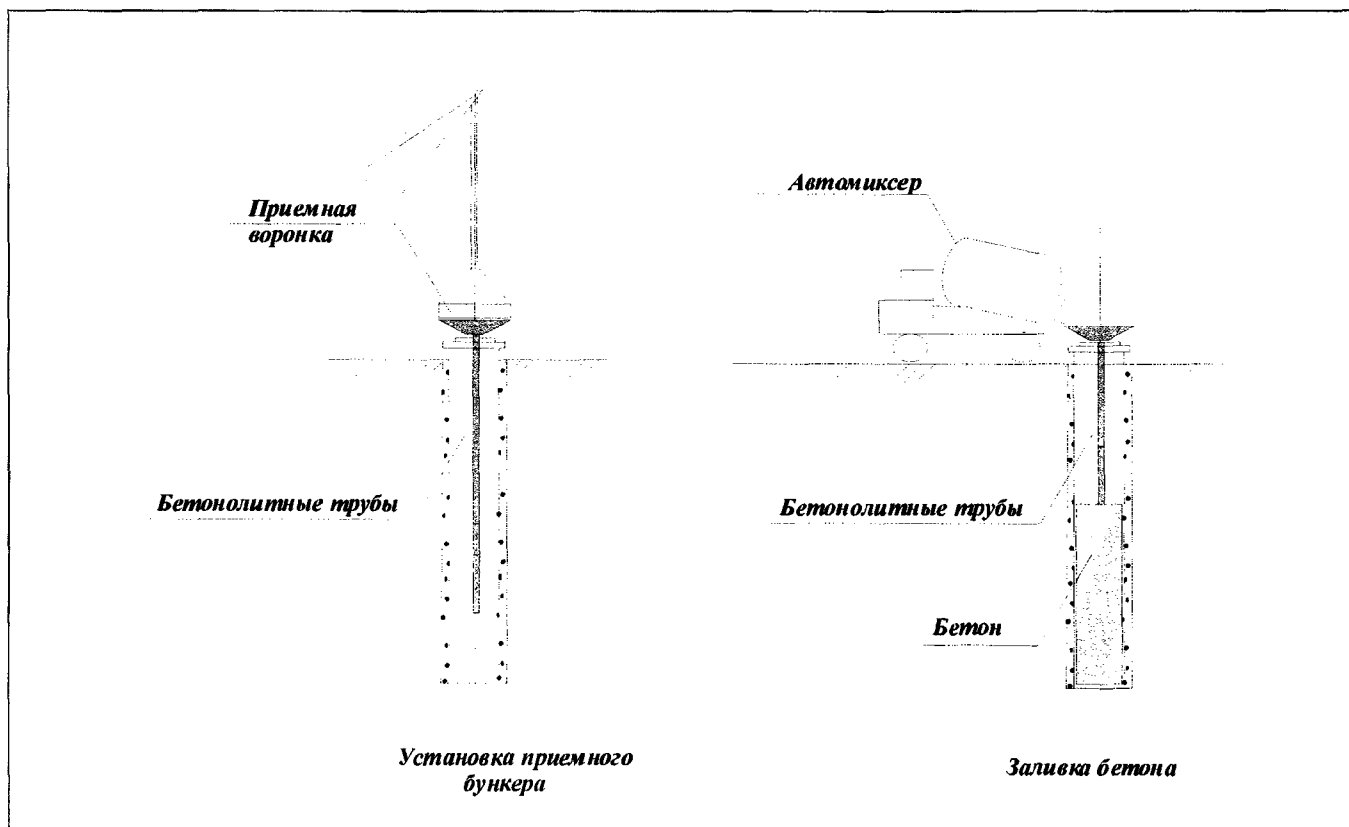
Схема укладки бетона в сваю-оболочку методом ВПТ
